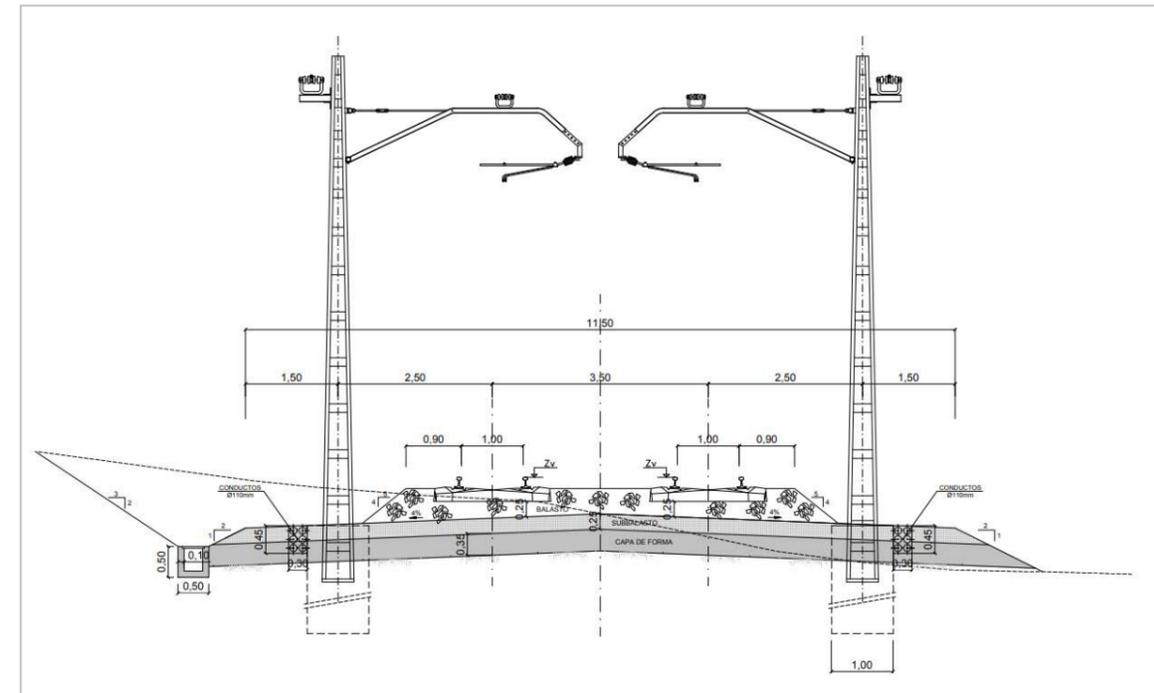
Sección tipo alzado. Fuente: INECO
